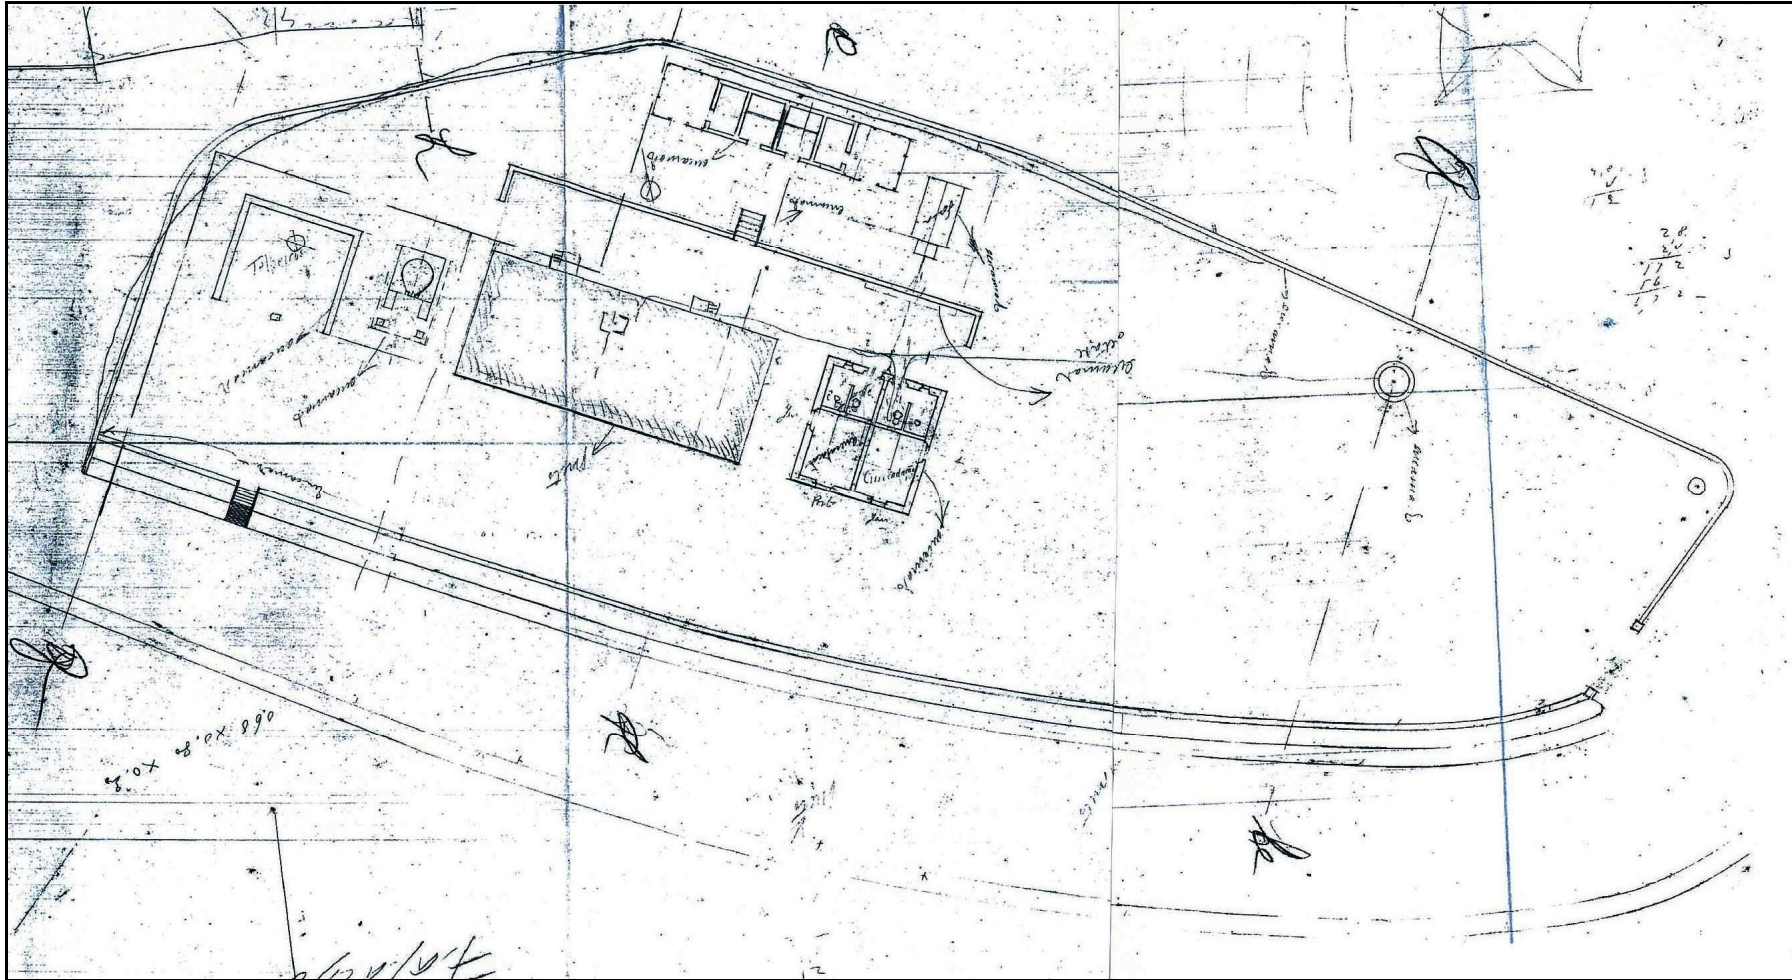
Planta do terreno do Falacho, com a casa de cantoneiros e os equipamentos anexos. 1937.
